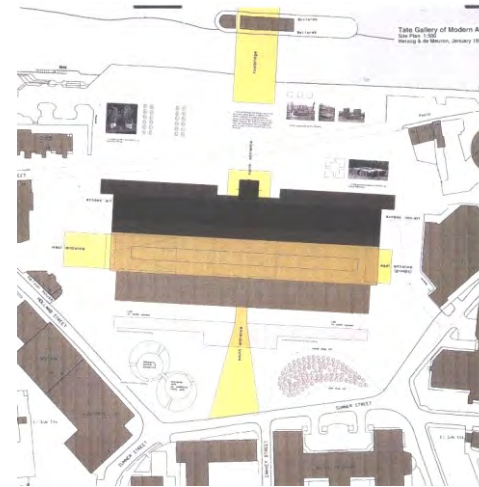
/ PLANTA DE CONJUNTO, EN LA QUE SE PUEDE APRECIAR LA EXPLANADA NORTE DE ACCESO
